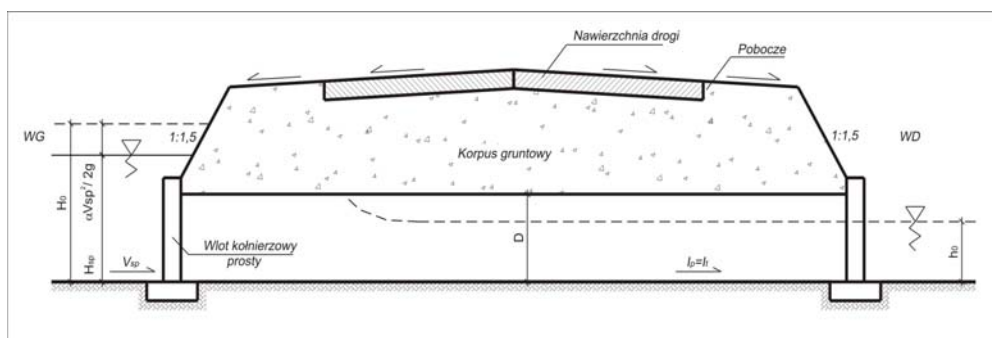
Schemat beziśnieniowej pracy przepustu
